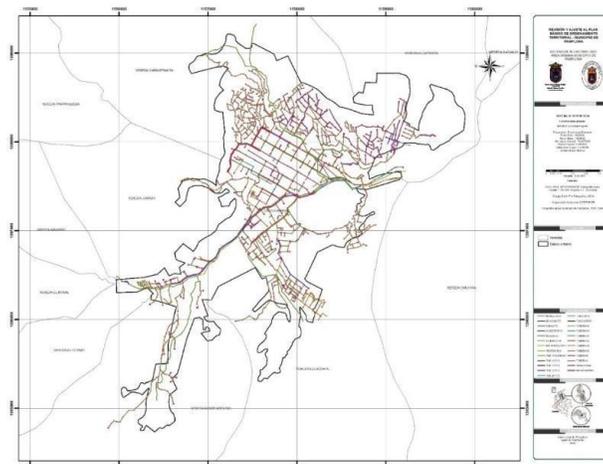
Sistema de alcantarillado en Pamplona. Fuente: PBOT.
